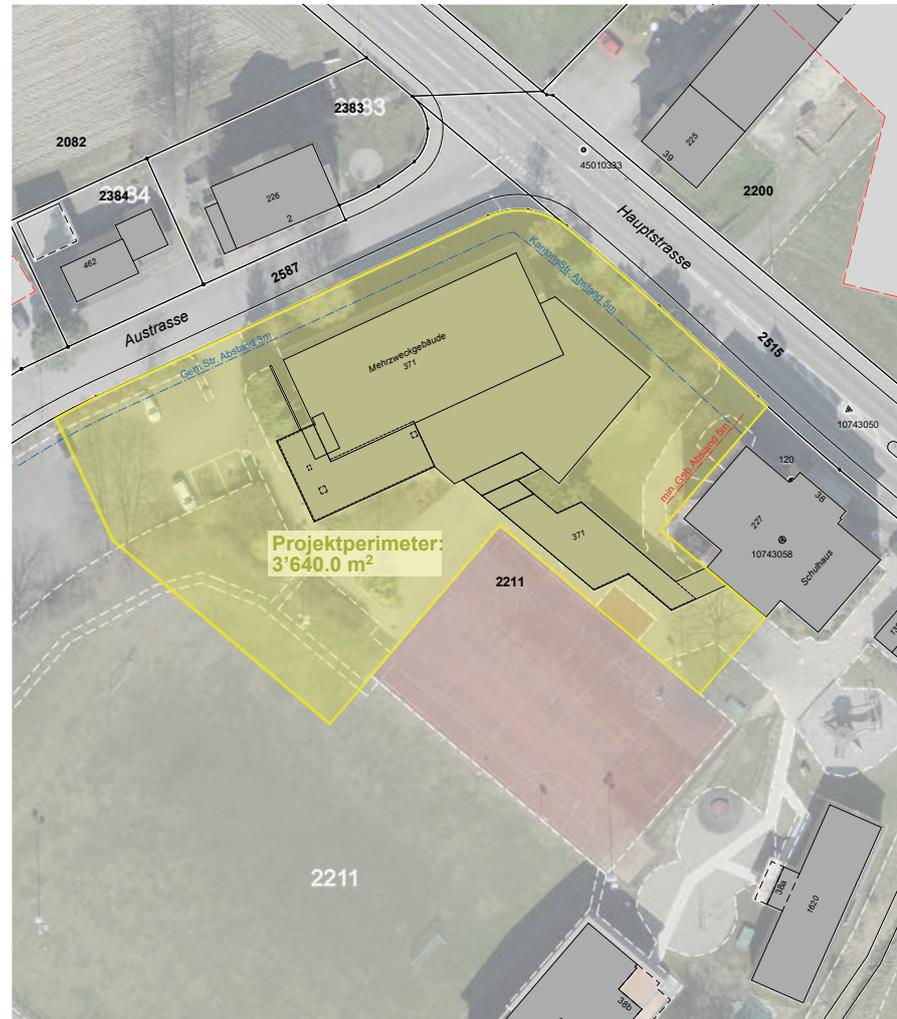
Situation / Projektperimeter Parzelle Nr. 2211
